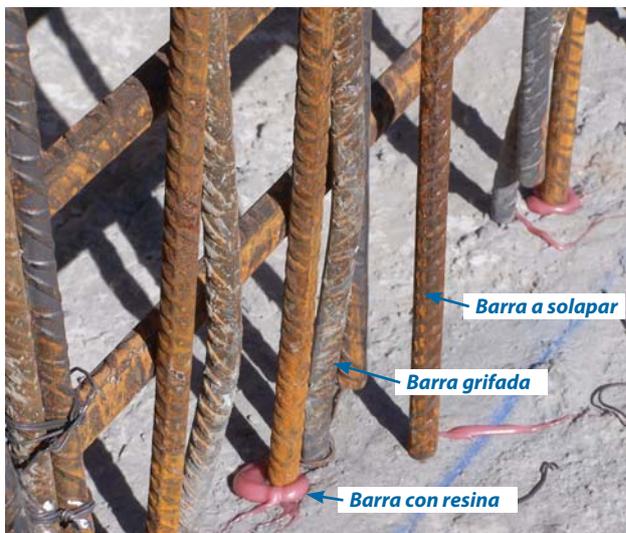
Práctica errónea ejecutada frecuentemente en obra.
